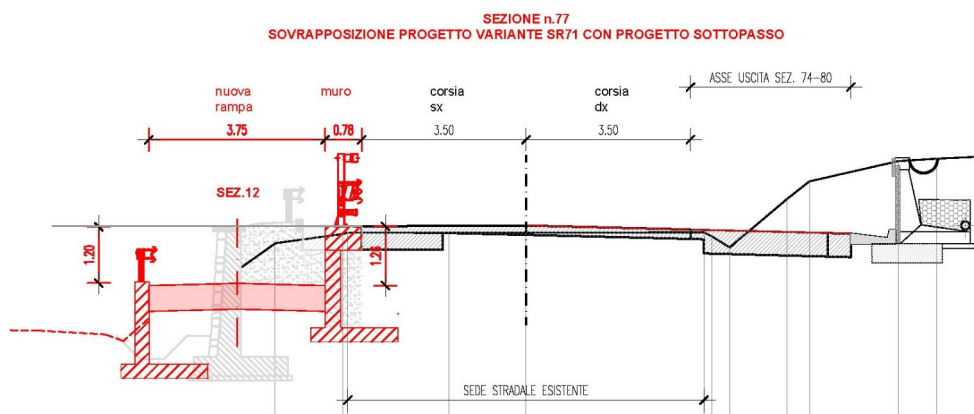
Progetto sottopasso sovrapposto a variante SRT 71: sezione n. 77
